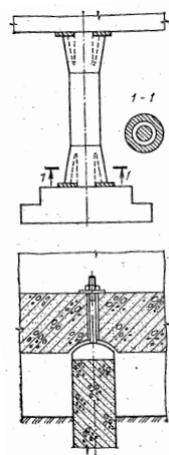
Конструкция свайного фундамента с высоким ростверком.
